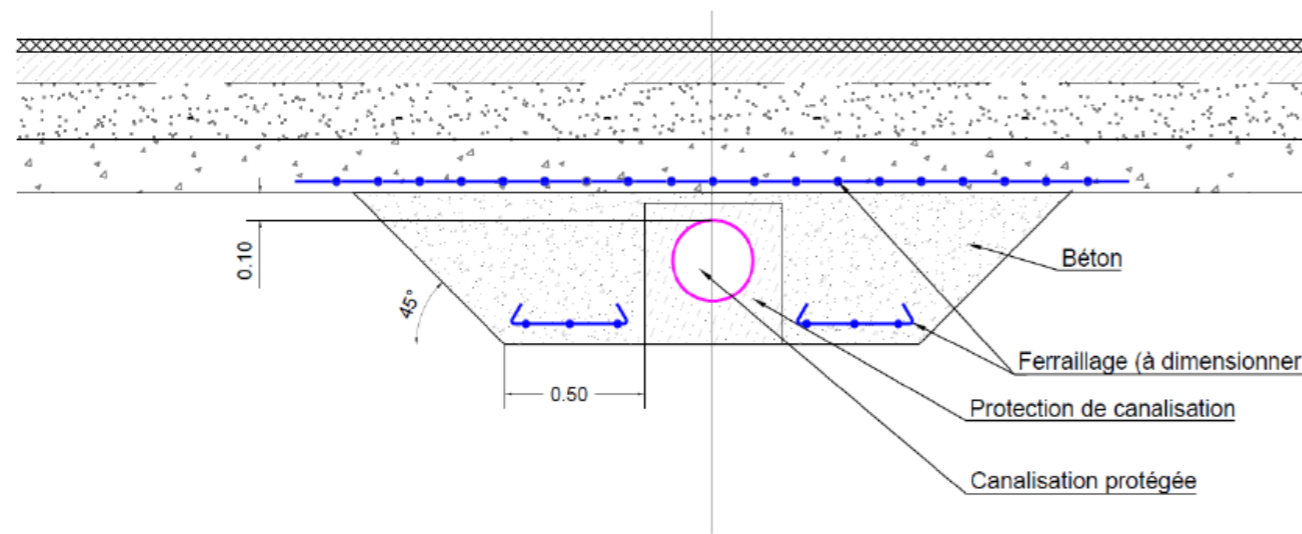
Coupe longitudinale de plateforme sur zone de pontage d'un réseau transversal
